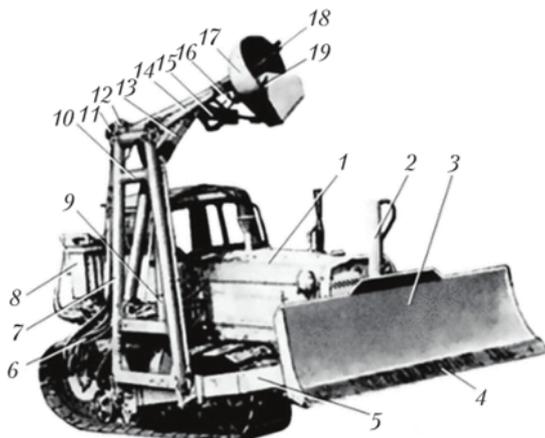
Фрезерный каналочиститель МР-7А: 1 — трактор; 2 — гидроцилиндр подъема отвала; 3 — отвал; 4 — нож; 5 — охватывающая рама; 6 — трубопроводы гидросистемы; 7 — стрела; 8 — масляный бак; 9 — гидроцилиндр поворота стрелы; 10 — распорка; 11 — стяжка; 12 — кронштейн; 13 — гидроцилиндр поворота рукояти; 14 — рукоять; 15 — гидроцилиндр поворота улитки; 16 — гидромотор; 17 — кожух с улиткой; 18 — фрезерный рабочий орган; 19 — нож лопатки
